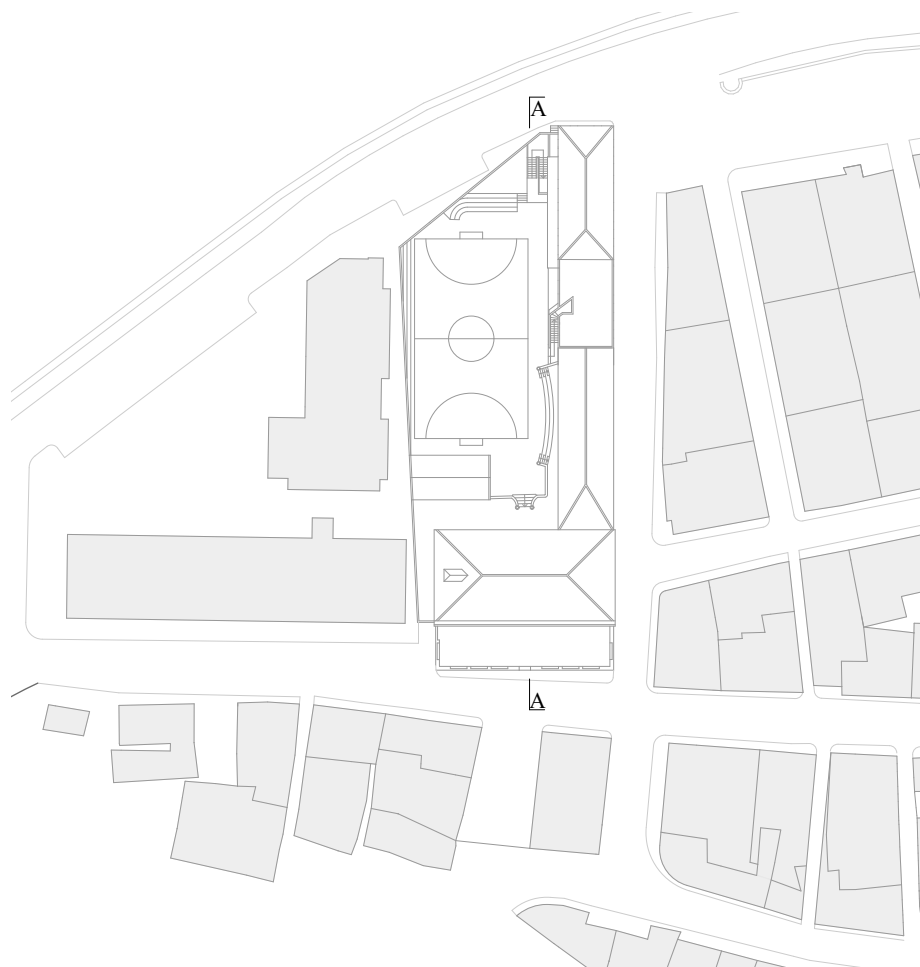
Planta de implantação da Escola Central. Esc. 1/1000.
